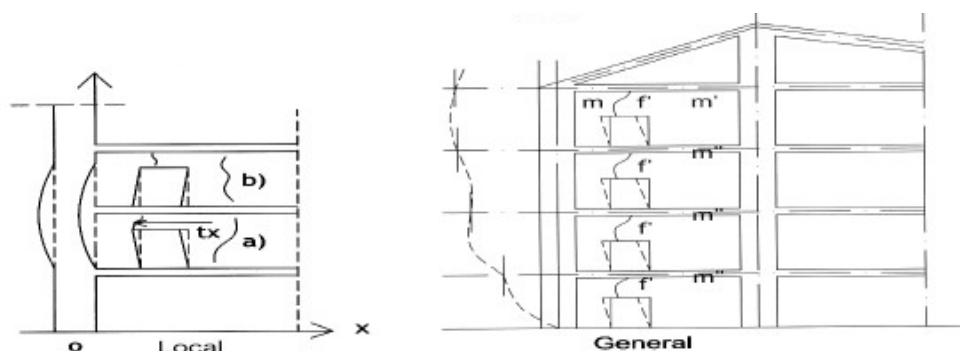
Efectele împingerilor și lipsei legăturilor structurale
